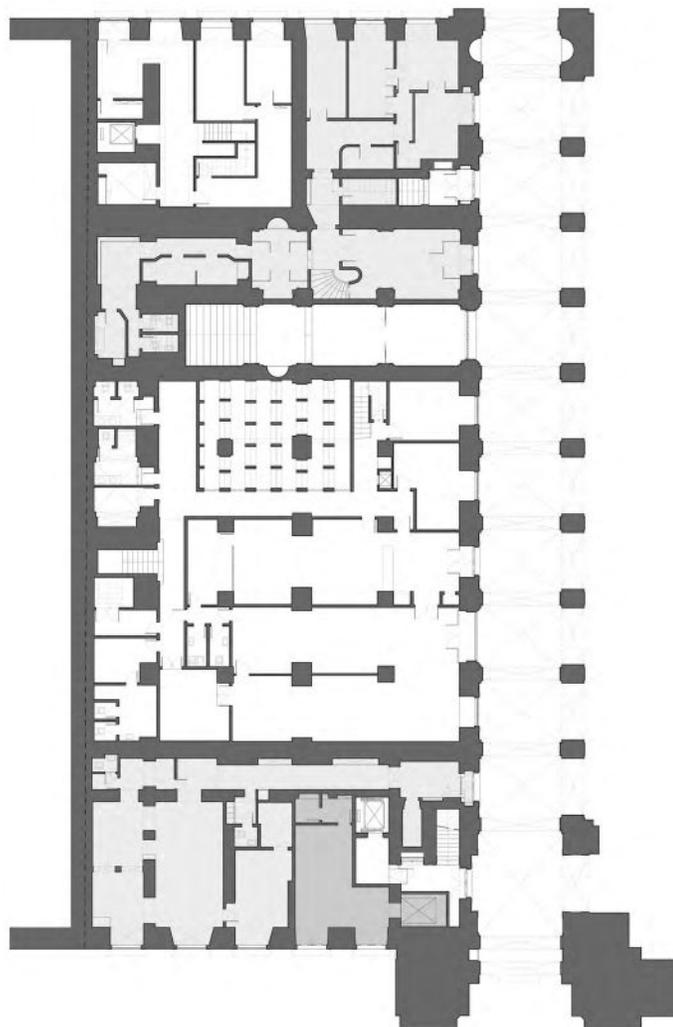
Planta do Piso Térreo — situação anterior à intervenção.
